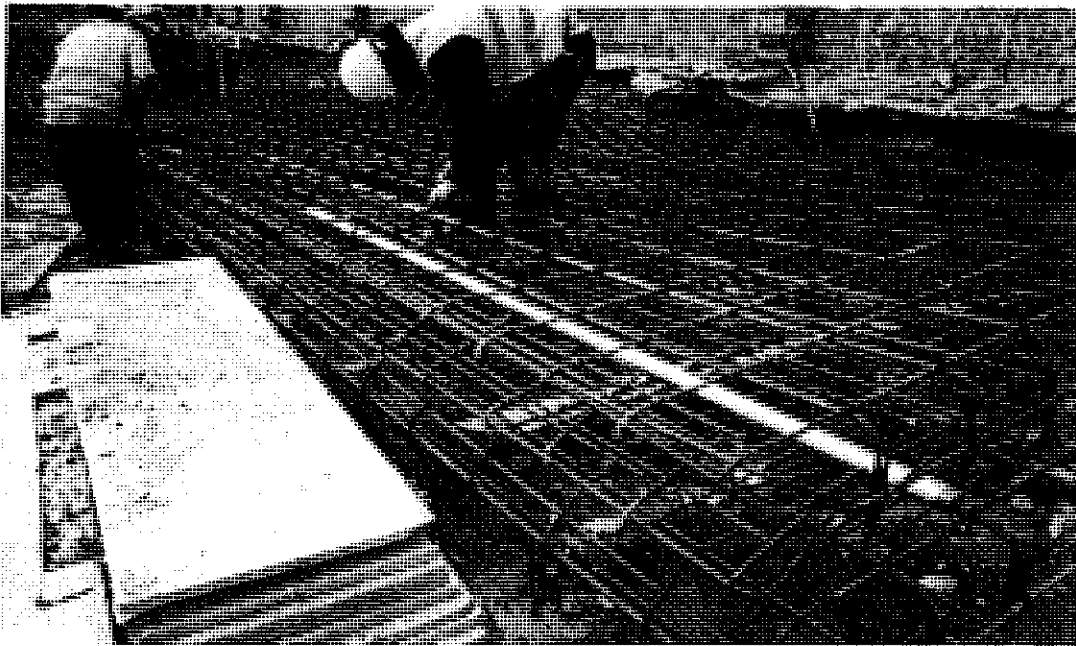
Vista de instalación de un inclinómetro en la armadura de una pantalla.
